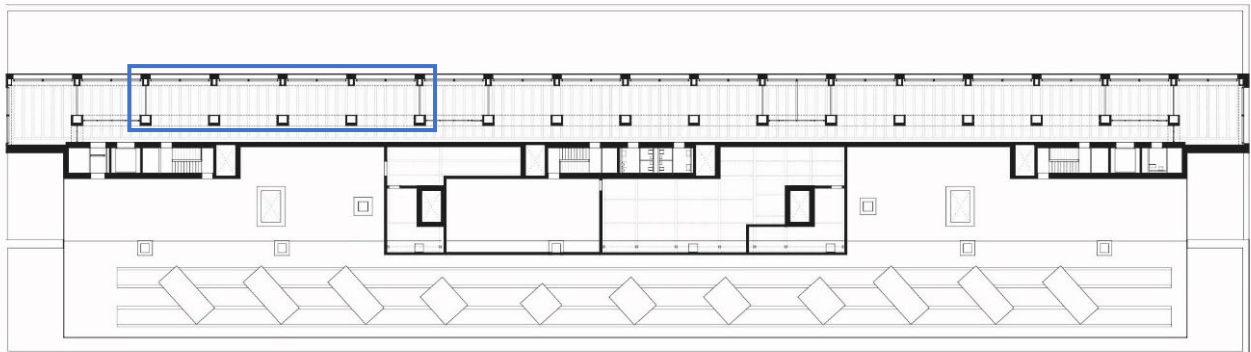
Campus SUPSI, Mendrisio - 4° piano
